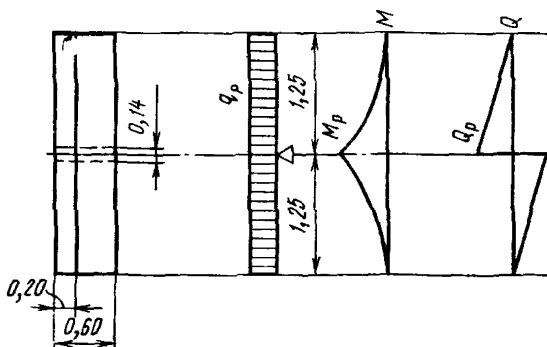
Схема к определению усилий в ребре анкерной плиты
